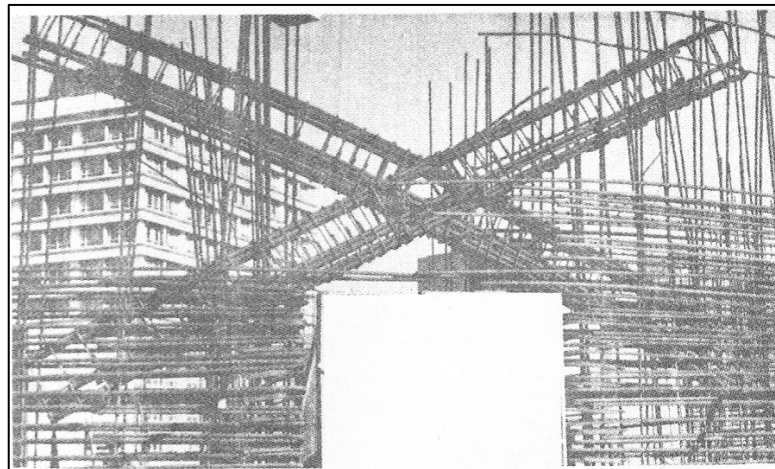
Refuerzo diagonal para una viga de acoplamiento de un muro de cortante
